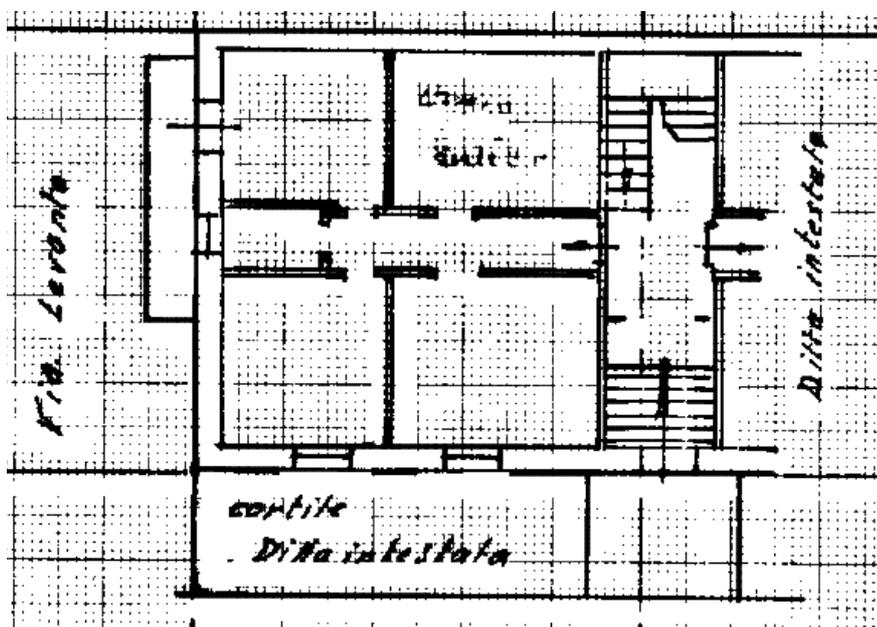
STRALCIO PLANIMETRICO DELL'U.I.U. OGGETTO DI ANALISI (FONTE: INTERNA).
